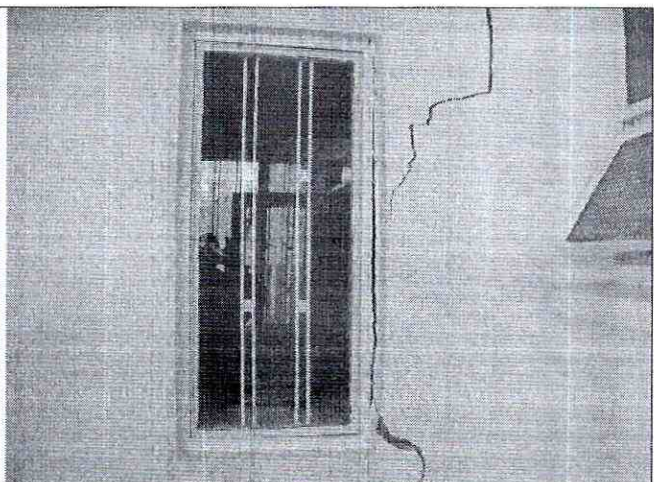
Agrietamientos en el muro de fachada del costado oriental de la vivienda.
